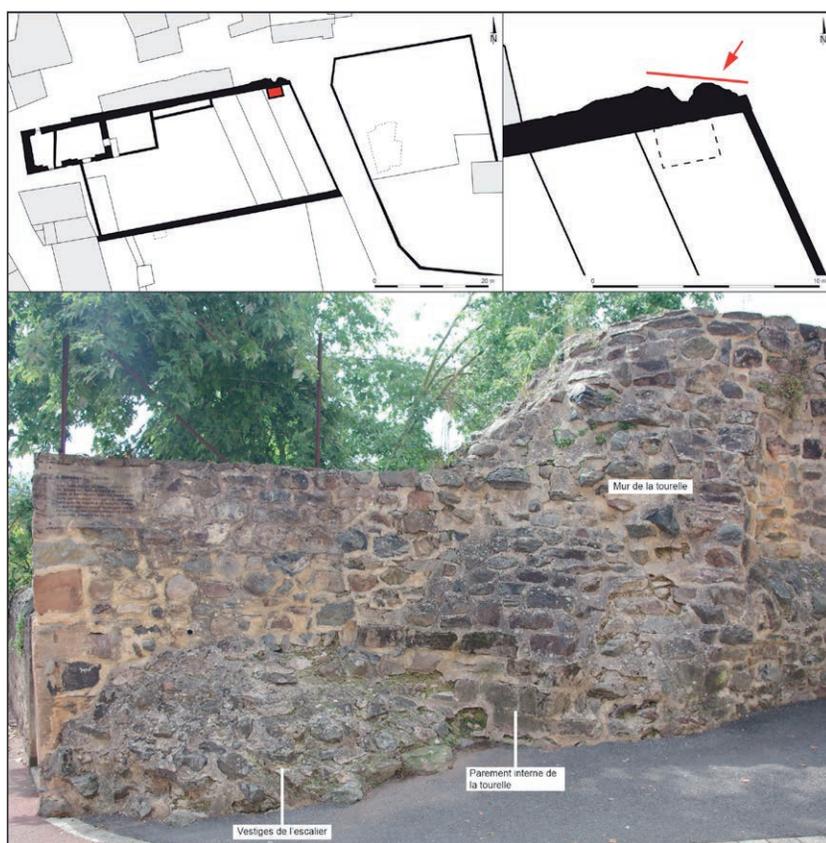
Emprise de la nef, étude du bâti sur le parement externe du mur gouttereau nord : vestiges d'une tourelle d'escalier placée à l'angle ouest du bras nord du transept (cl. Olivia Puel, 2011).
